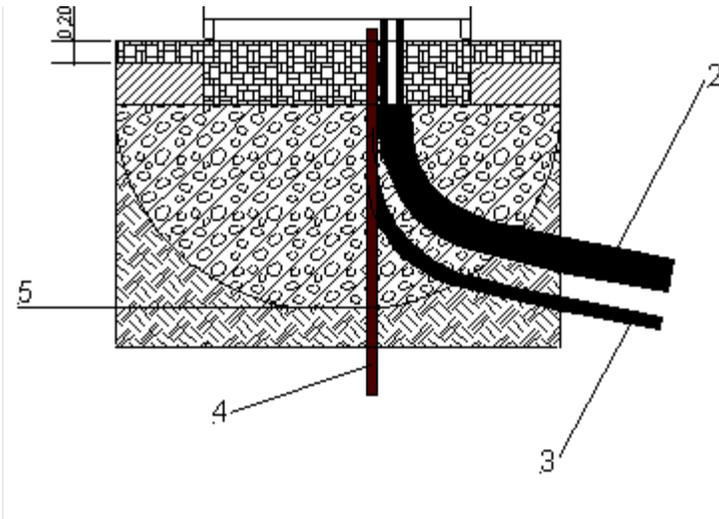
Piano di fondazione pompa di calore con scarico condensa
